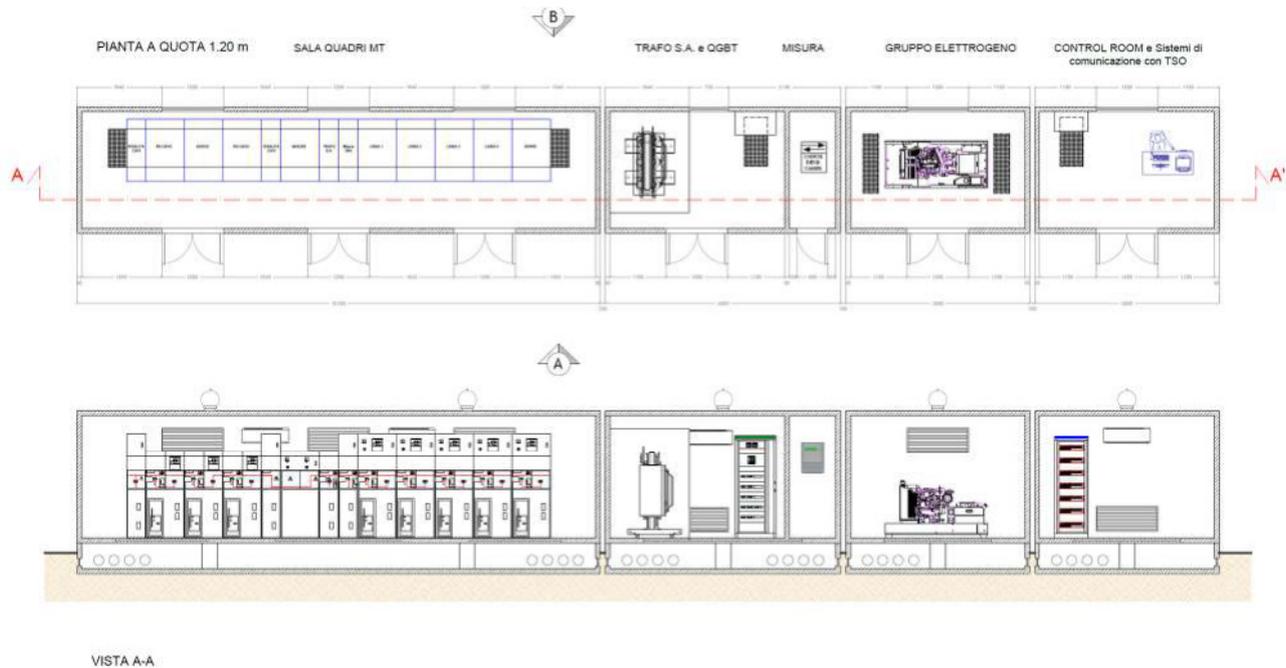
Particolare pianta e sezione cabina di raccolta e smistamento (rif. FV.APR01.PD.H.02)
